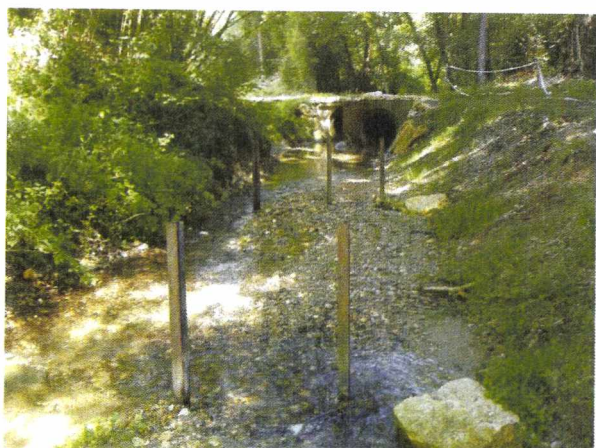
Quelques pieux ont également été mis en place sur un site accessible en amont par un passage à gué, permettant de réaliser l'entretien
